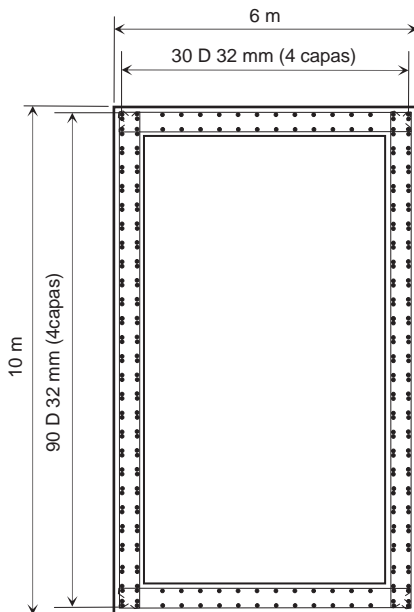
Refuerzo transversal en las secciones del puente (imagen modificada de Álvarez, 2004)
